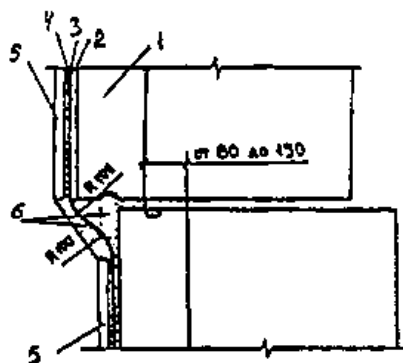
Конструкция сопряжения гидроизоляции стен в местах изменения ширины тоннеля:
